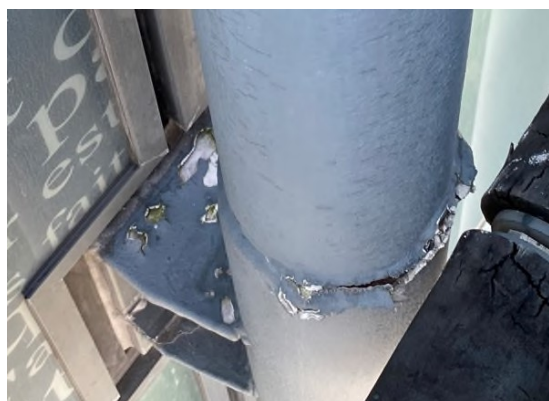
R+11 dégradation à la jonction entre tronçons de poteaux
